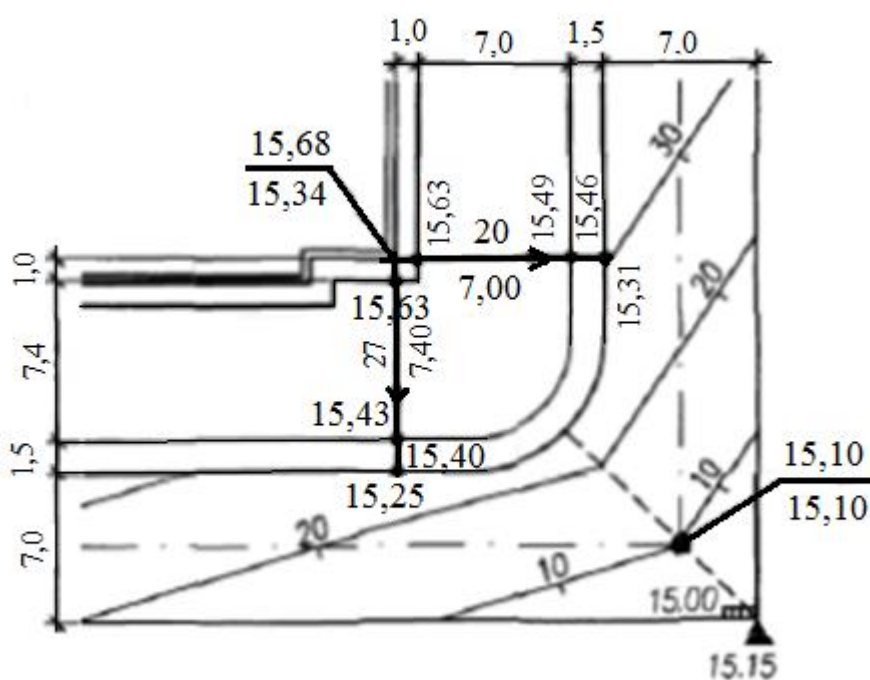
Фрагмент схемы высотной посадки здания
